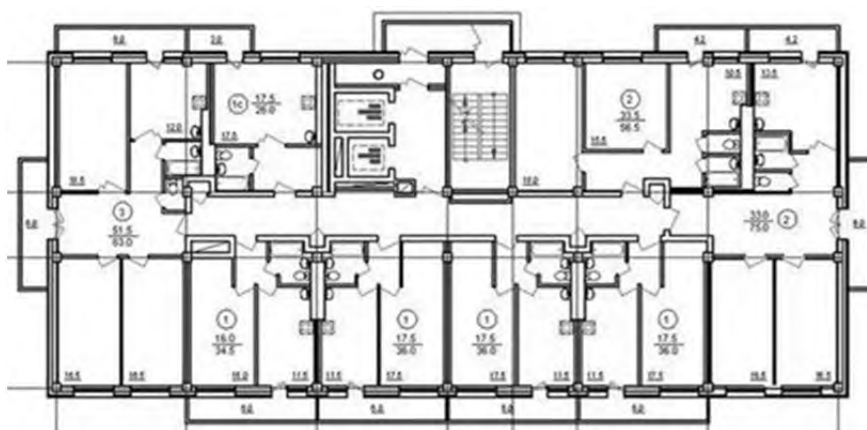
План типового этажа каркасной монолитной конструктивной системы
